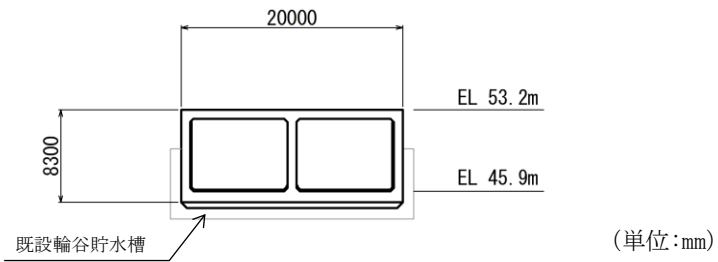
(1) 輪谷貯水槽（西側）の断面図（A-A断面）
